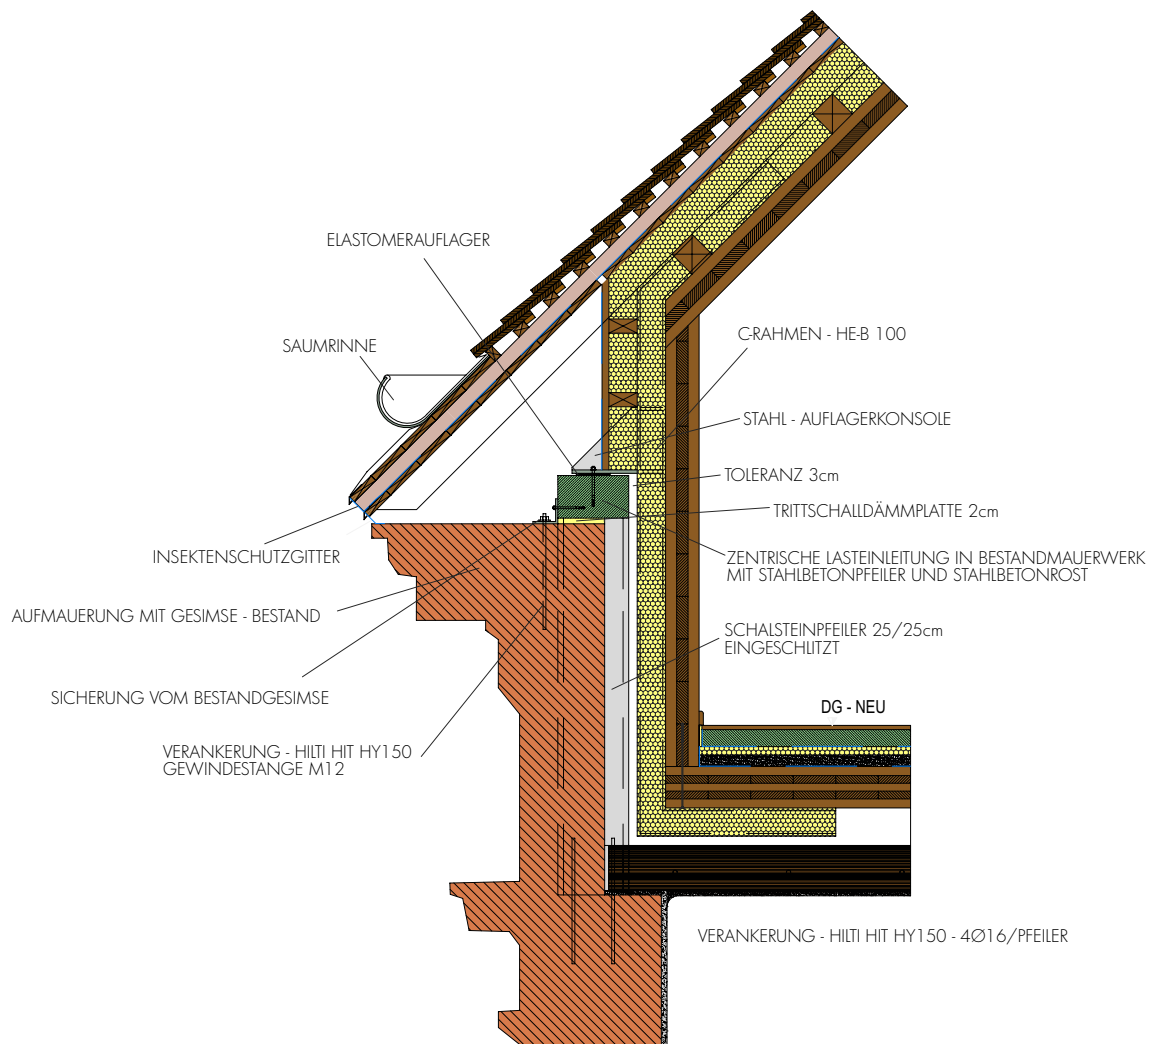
Mögliches Traufdetail für eine Variante mit Schrägdach - Faltwerklösung mit Brettsper Holz [Quelle: G. Prügger]
